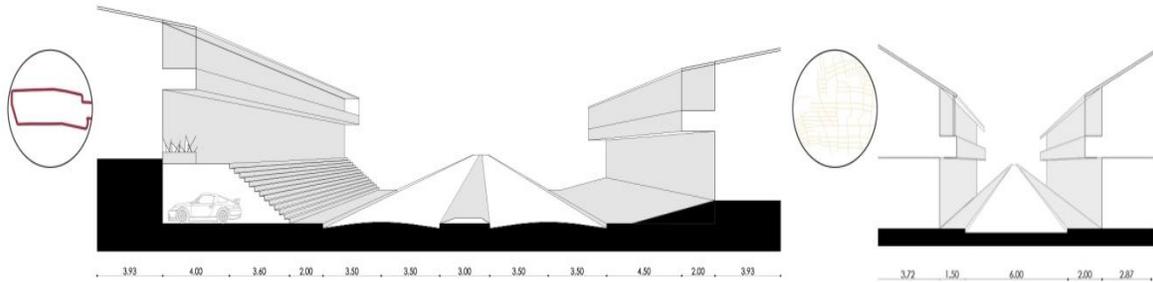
Tipologías de sección en relación al anillo y demás estructuras del sistema vial
